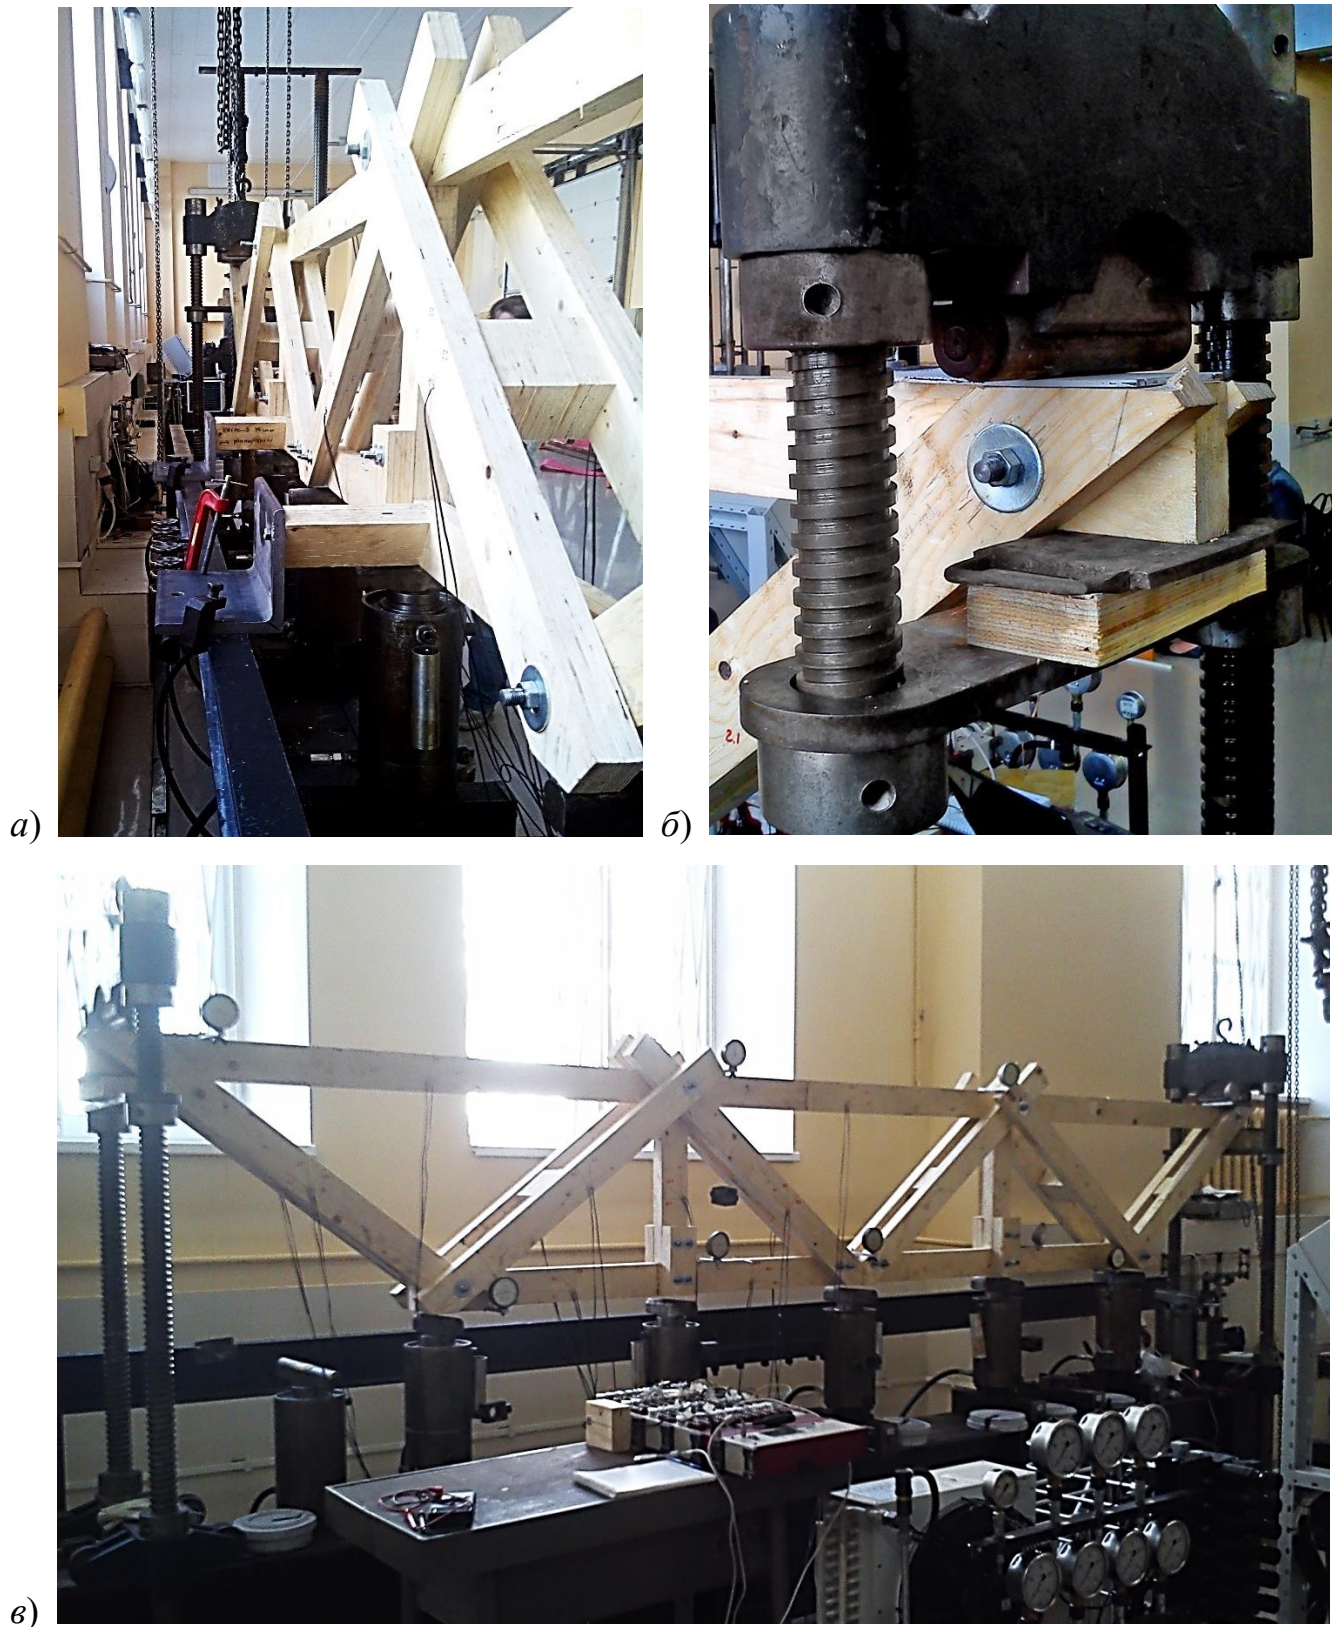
Испытуемая ферма: *а)* раскрепление из плоскости верхнего пояса фермы, *б)* опорный узел фермы, *в)* внешний вид конструкции.
